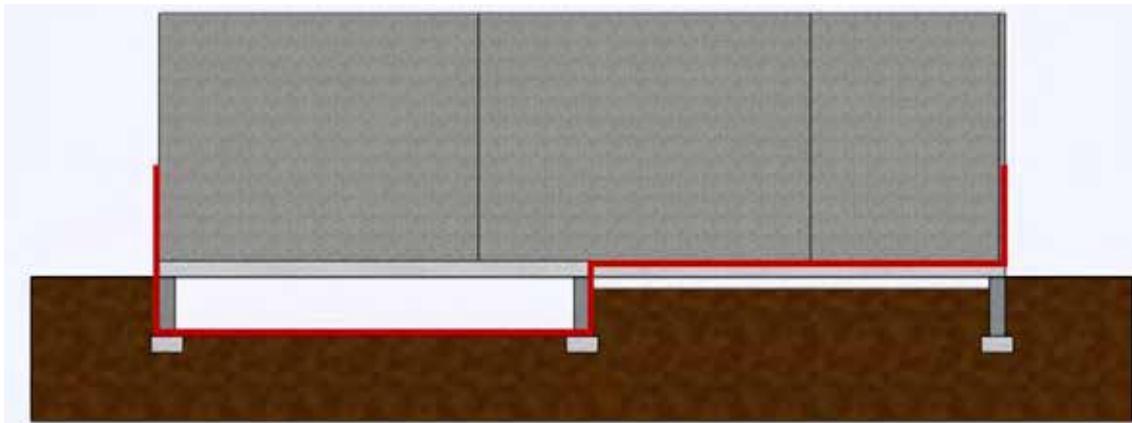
Types de chargement appliqués sur les murs en panneaux TimberRoc
